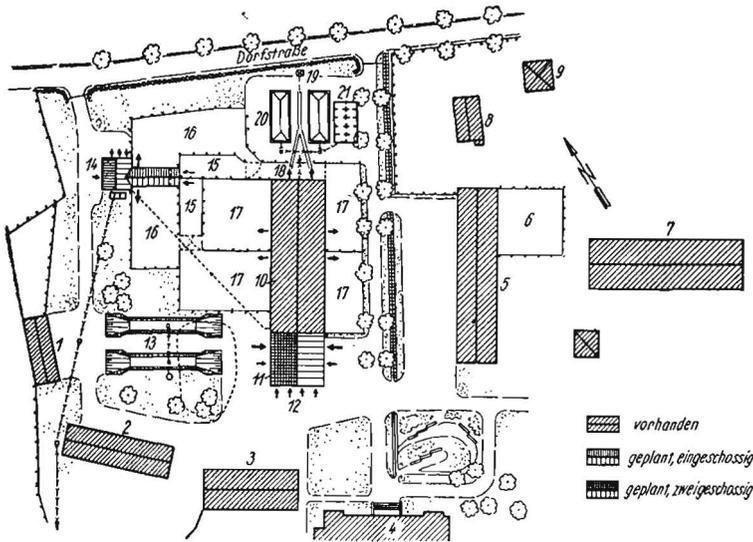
Lageplan zum Vorschlag des Umbaus in einen Laufstall
